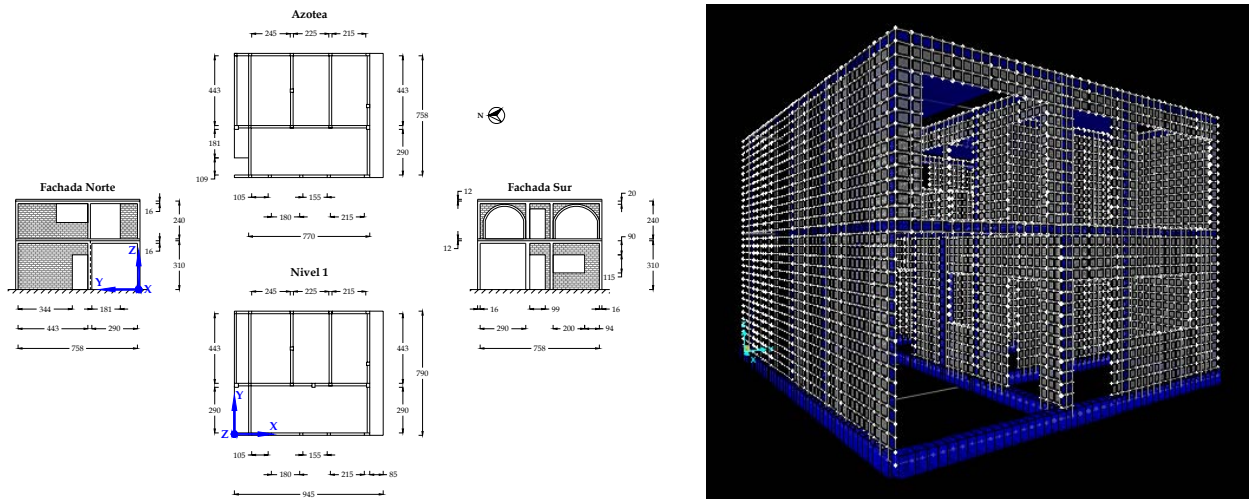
Modelo estructural de la vivienda 2.
